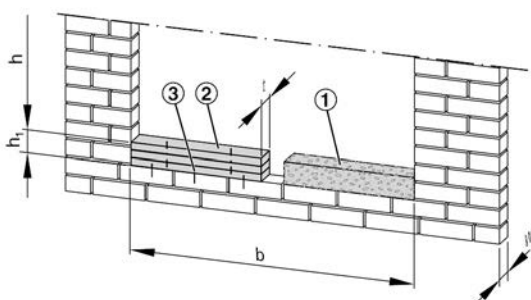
Einbauöffnung mit Auffütterung zur Höhenanpassung
